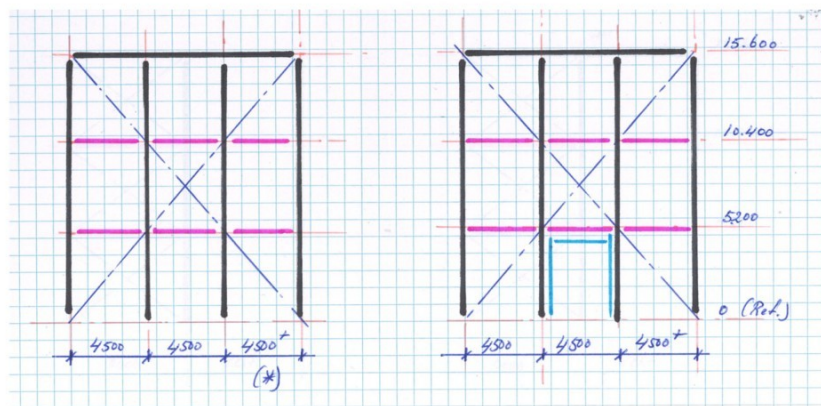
Constructief ontwerp dakconstructie met stabiliteitsverbanden.
